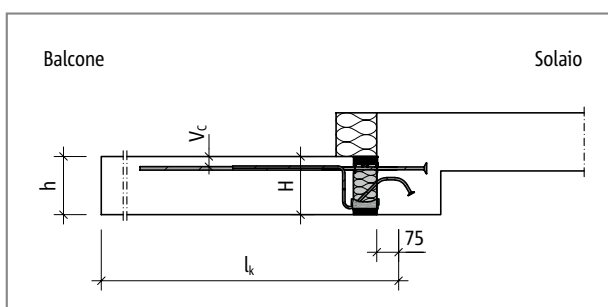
Schöck Isokorb® T tipo KL-U: schema statico
